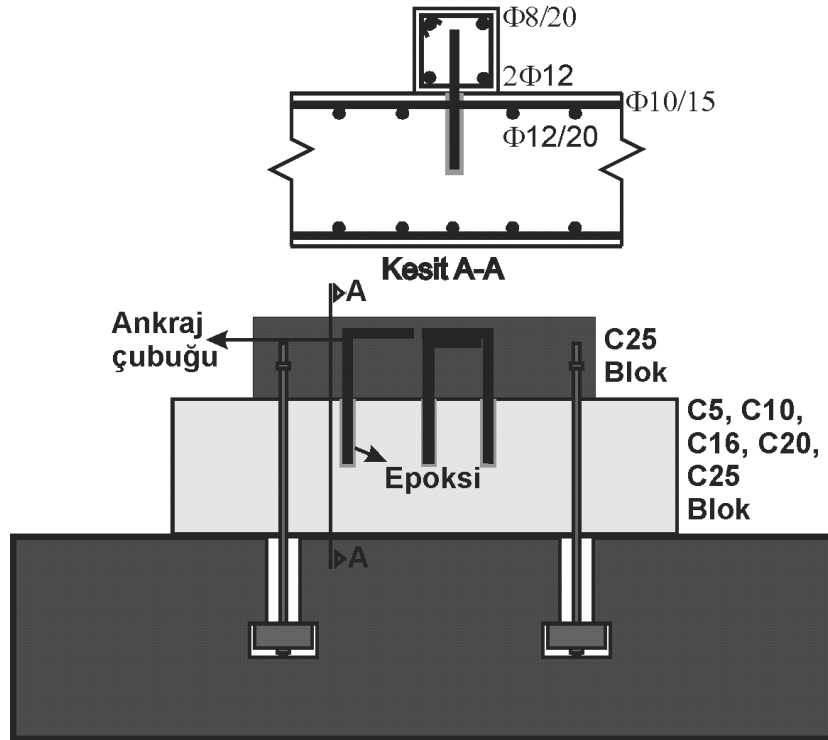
Temelin üzerinde ankrajla bağlanan betonarme bloklar
